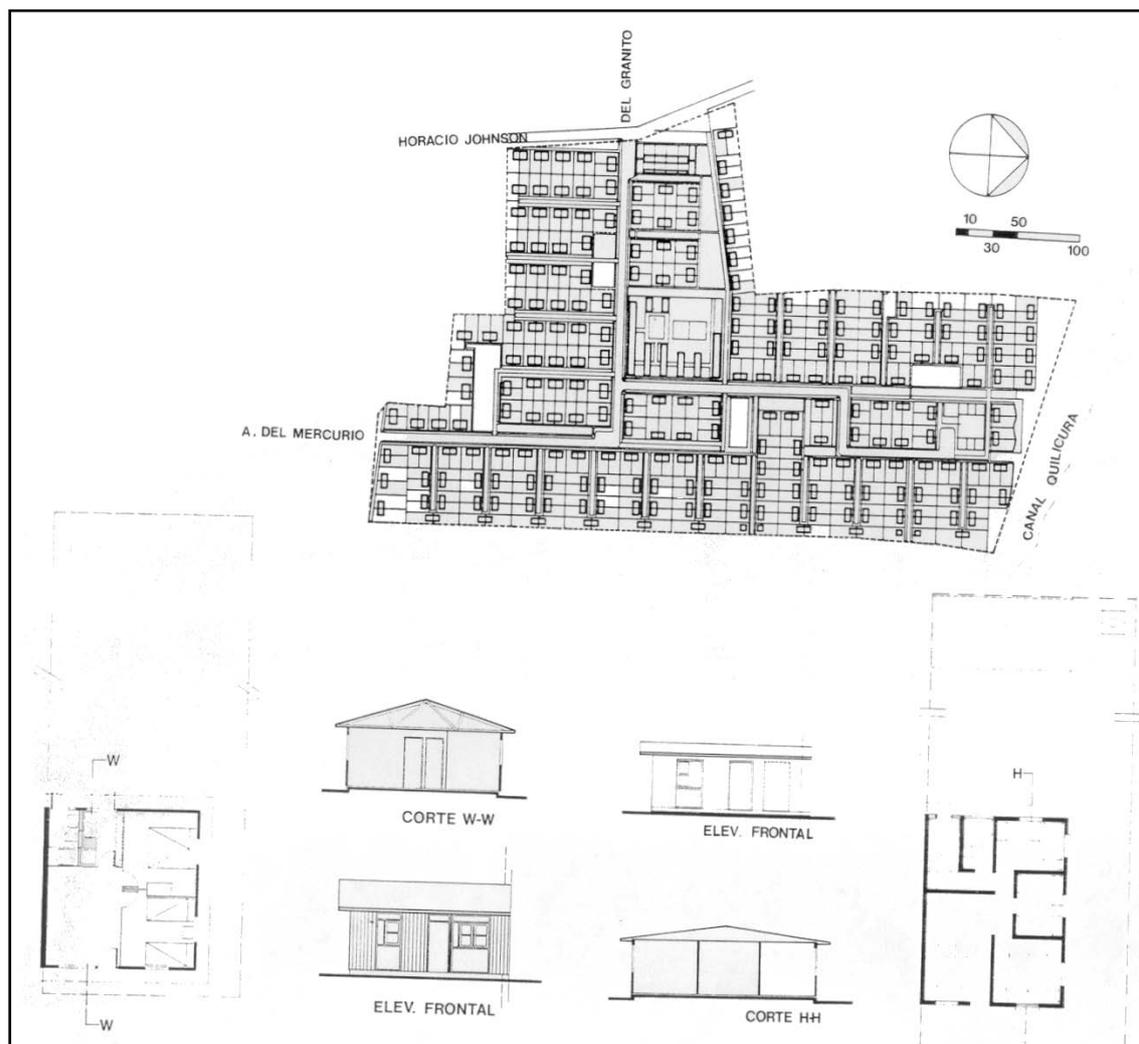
Población Conchalí. Plano del Conjunto y viviendas tipo.
